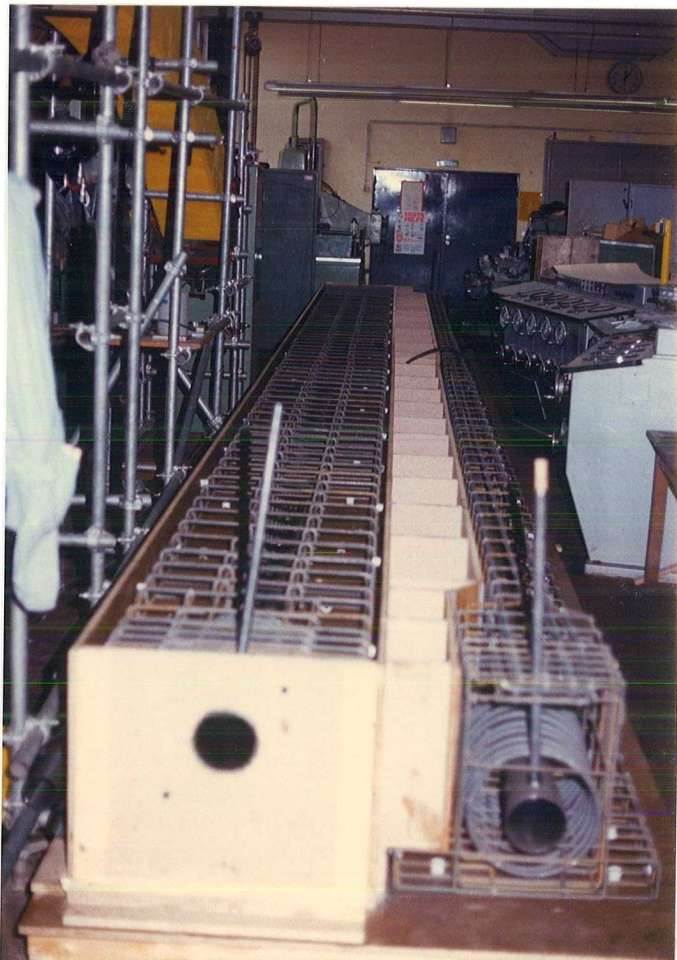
Aufbau der Schalung mit Bewehrung und Hüllrohr
